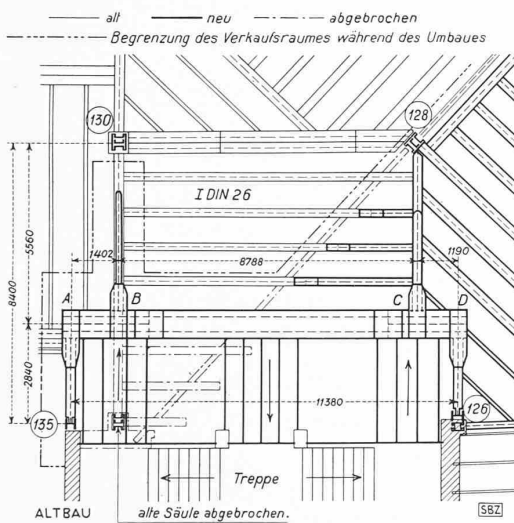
Grundriss des Torsionsträgers. — 1:200
